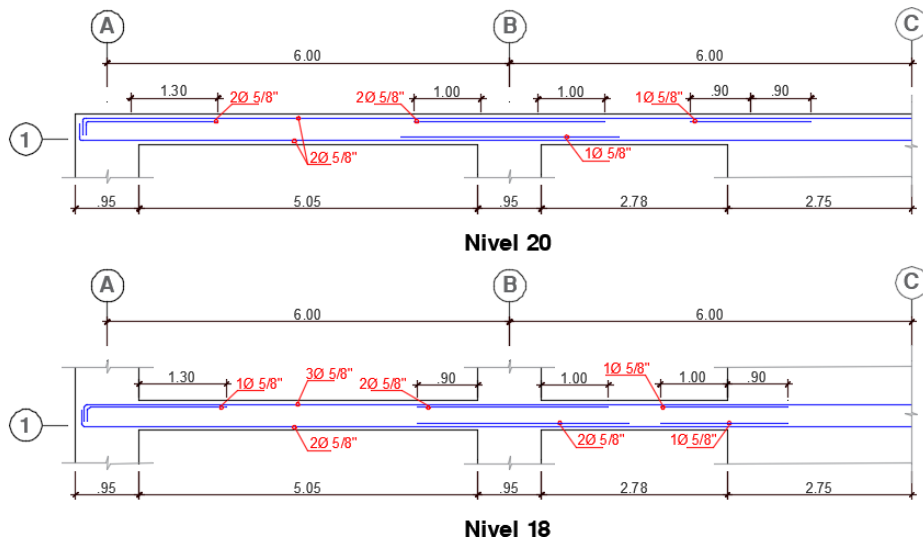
Refuerzo requerido por flexo-tracción en las vigas para el edificio Edi-20
